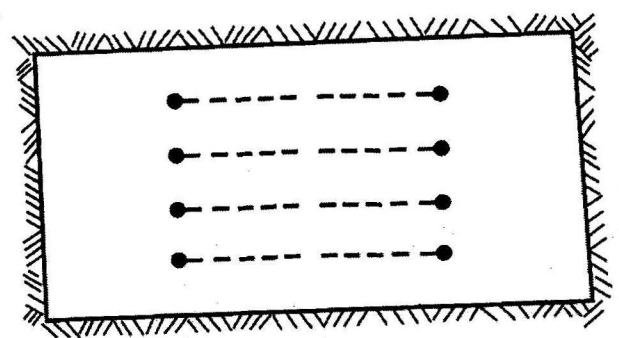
Corte en cuña en los pozos verticales de sección rectangular.
